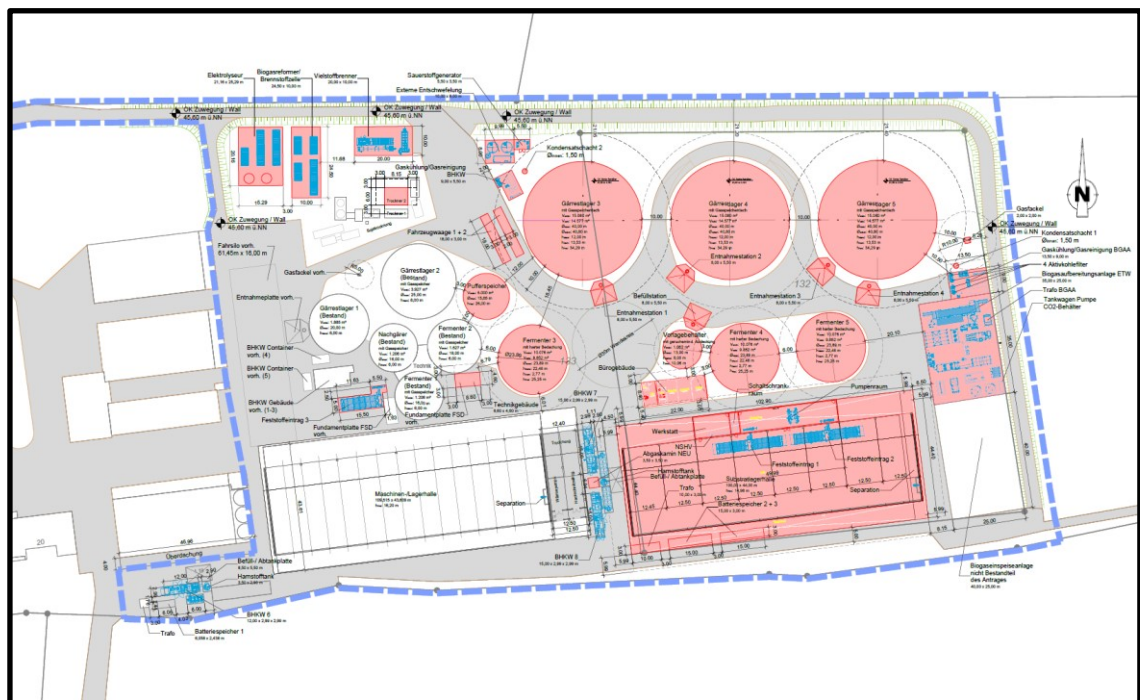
Ausschnitt aus Lageplan; Quelle: /U1/
